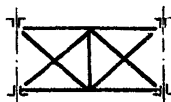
Схема решетки вертикальной связевой фермы высотой 3 м и более
